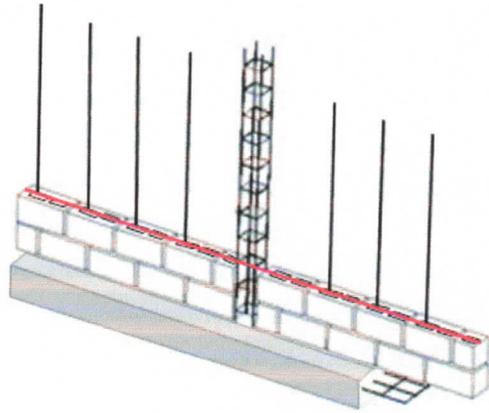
Primeras hiladas de bloques y colocación del acero horizontal.
